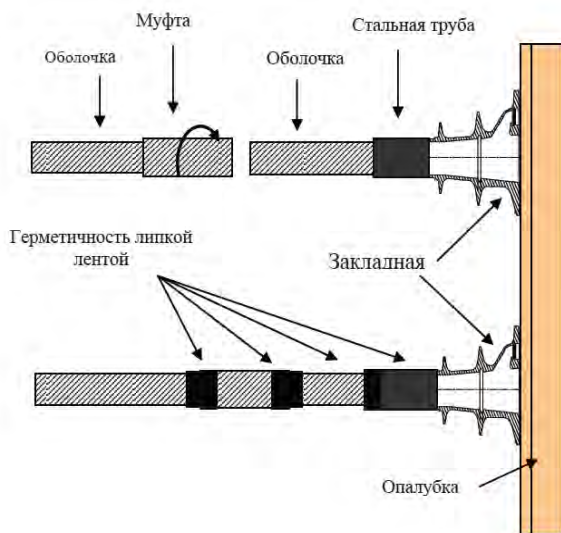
Схема соединения гофрированной оболочки с закладной деталью
